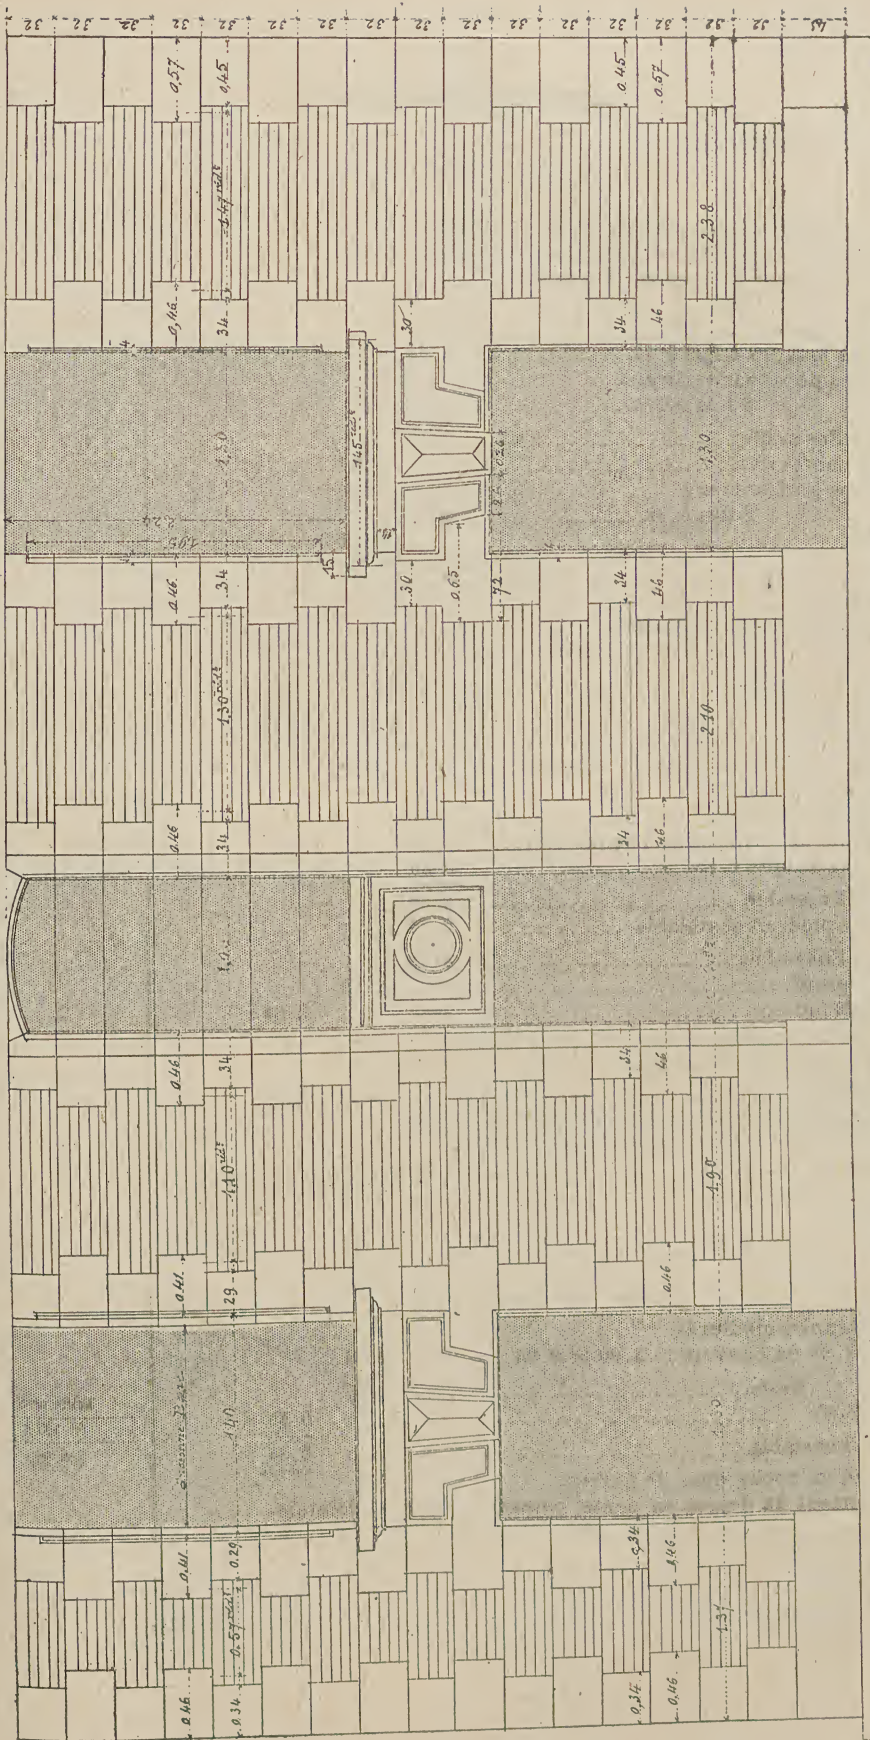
Ravalement sur pierre vieille et sur briques, 2^e et 3^e étages sur rue. — Élévation du ravalement.
